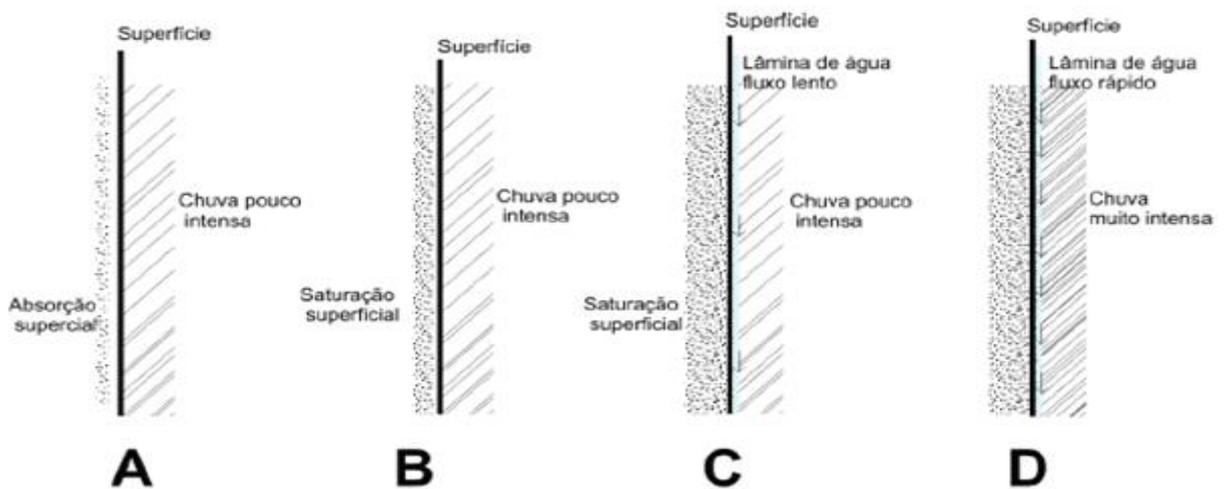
Fases de interação da água nas alvenarias das fachadas.
